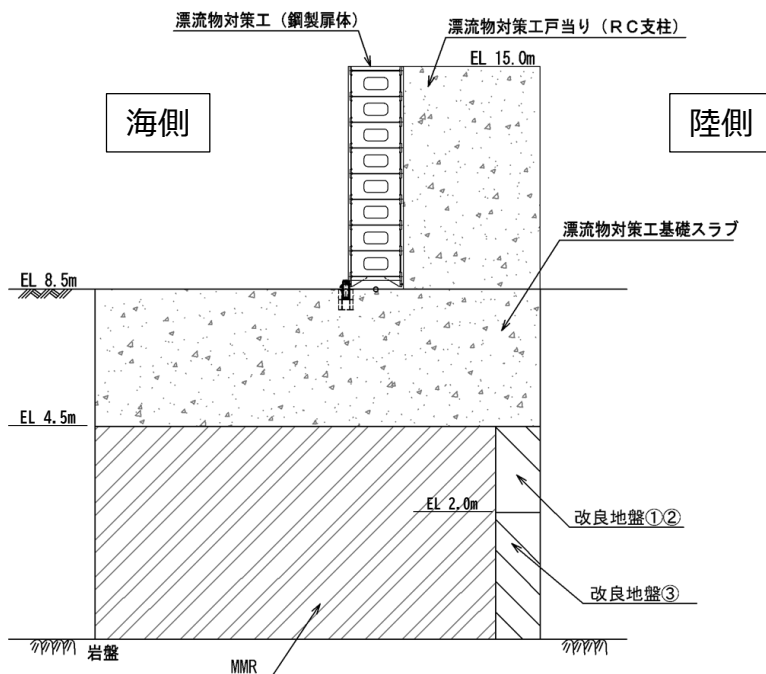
(2) 漂流物対策工の構造図 (基礎断面図, C-C 断面)
